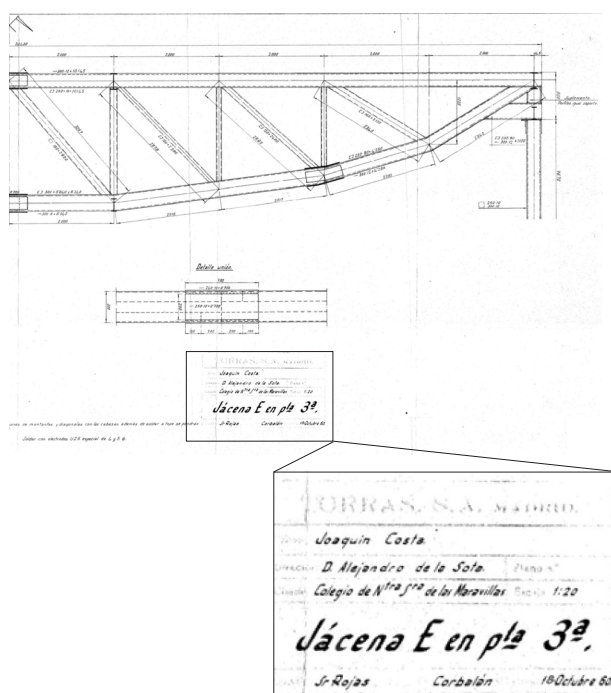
Detalle del alzado de la cercha del Gimnasio Maravillas llevada a cabo por la oficina de Eusebio Rojas-Marcos. Aparece reflejada la firma del ingeniero en la parte inferior del plano.
